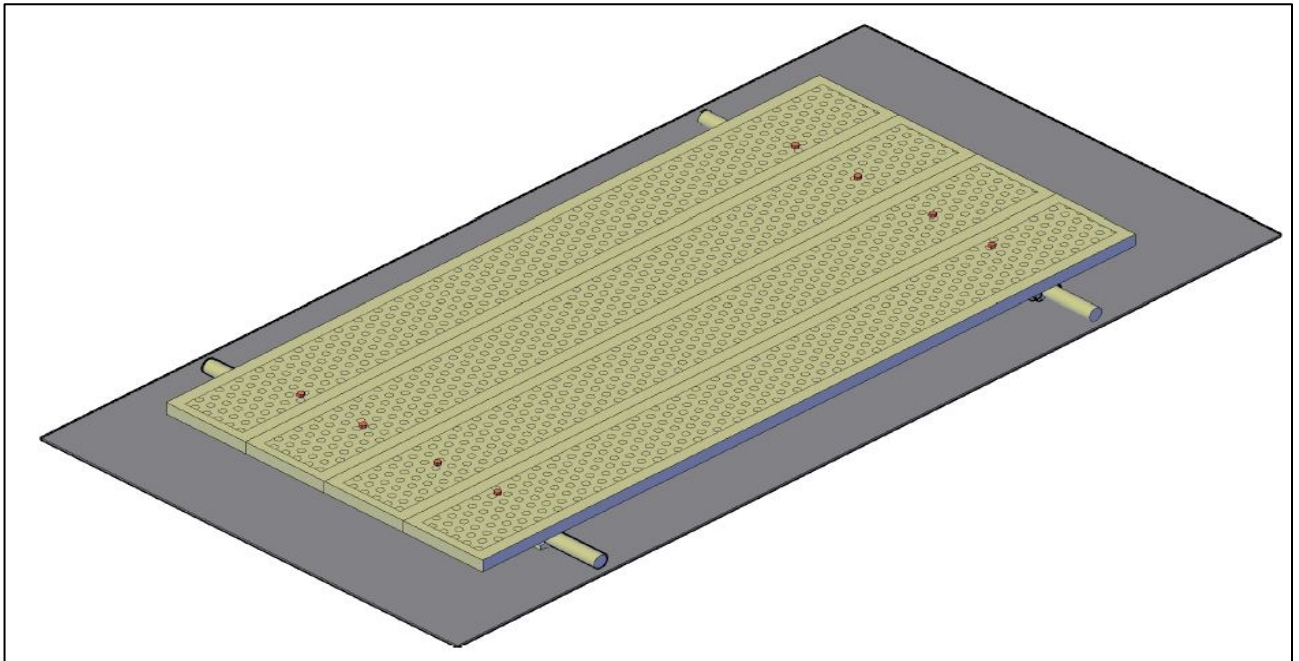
Изометрический вид инвентарного перекрытия проемов с использованием сварных соединений и планок перекрытий
